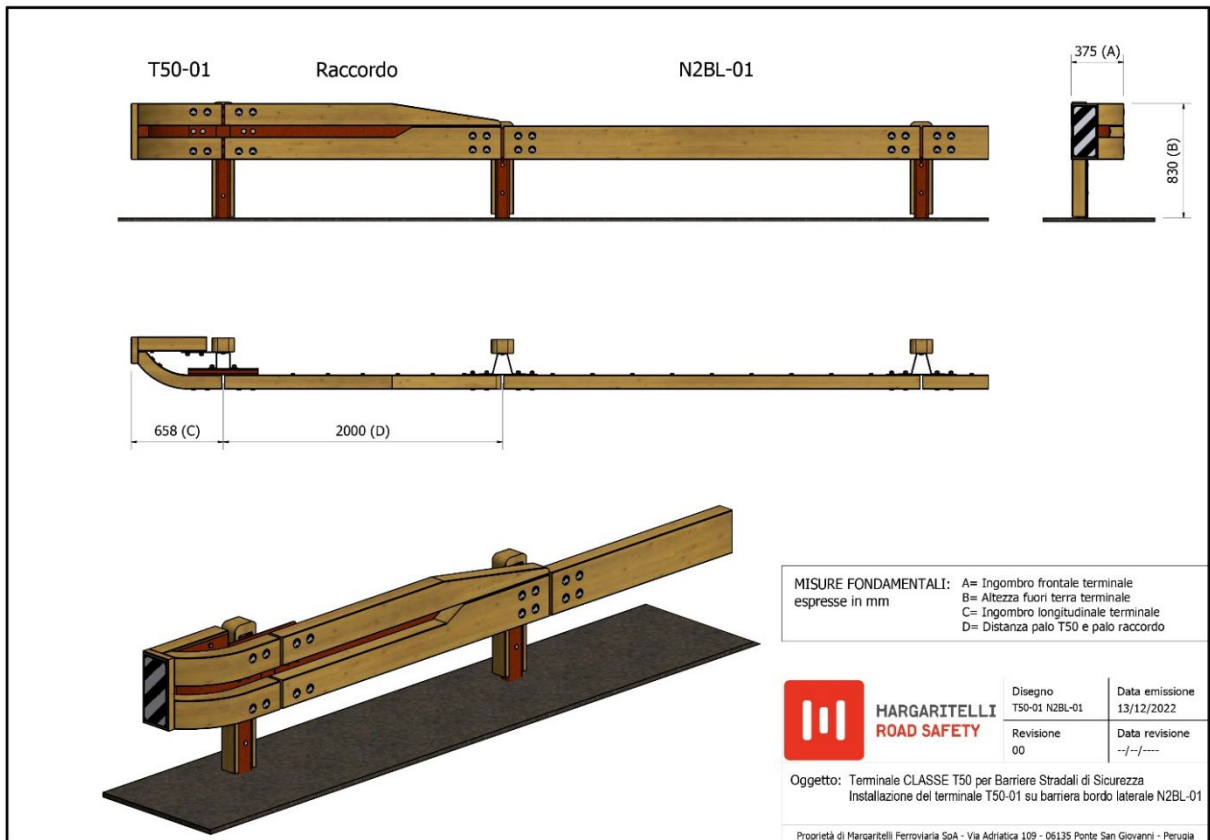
schema di collegamento tra barriera bordo laterale e terminale T50-01
